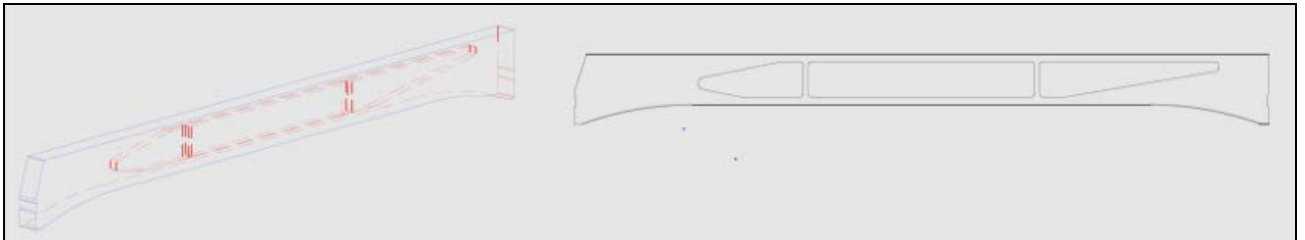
Modelagem da viga-guia Tipo.
